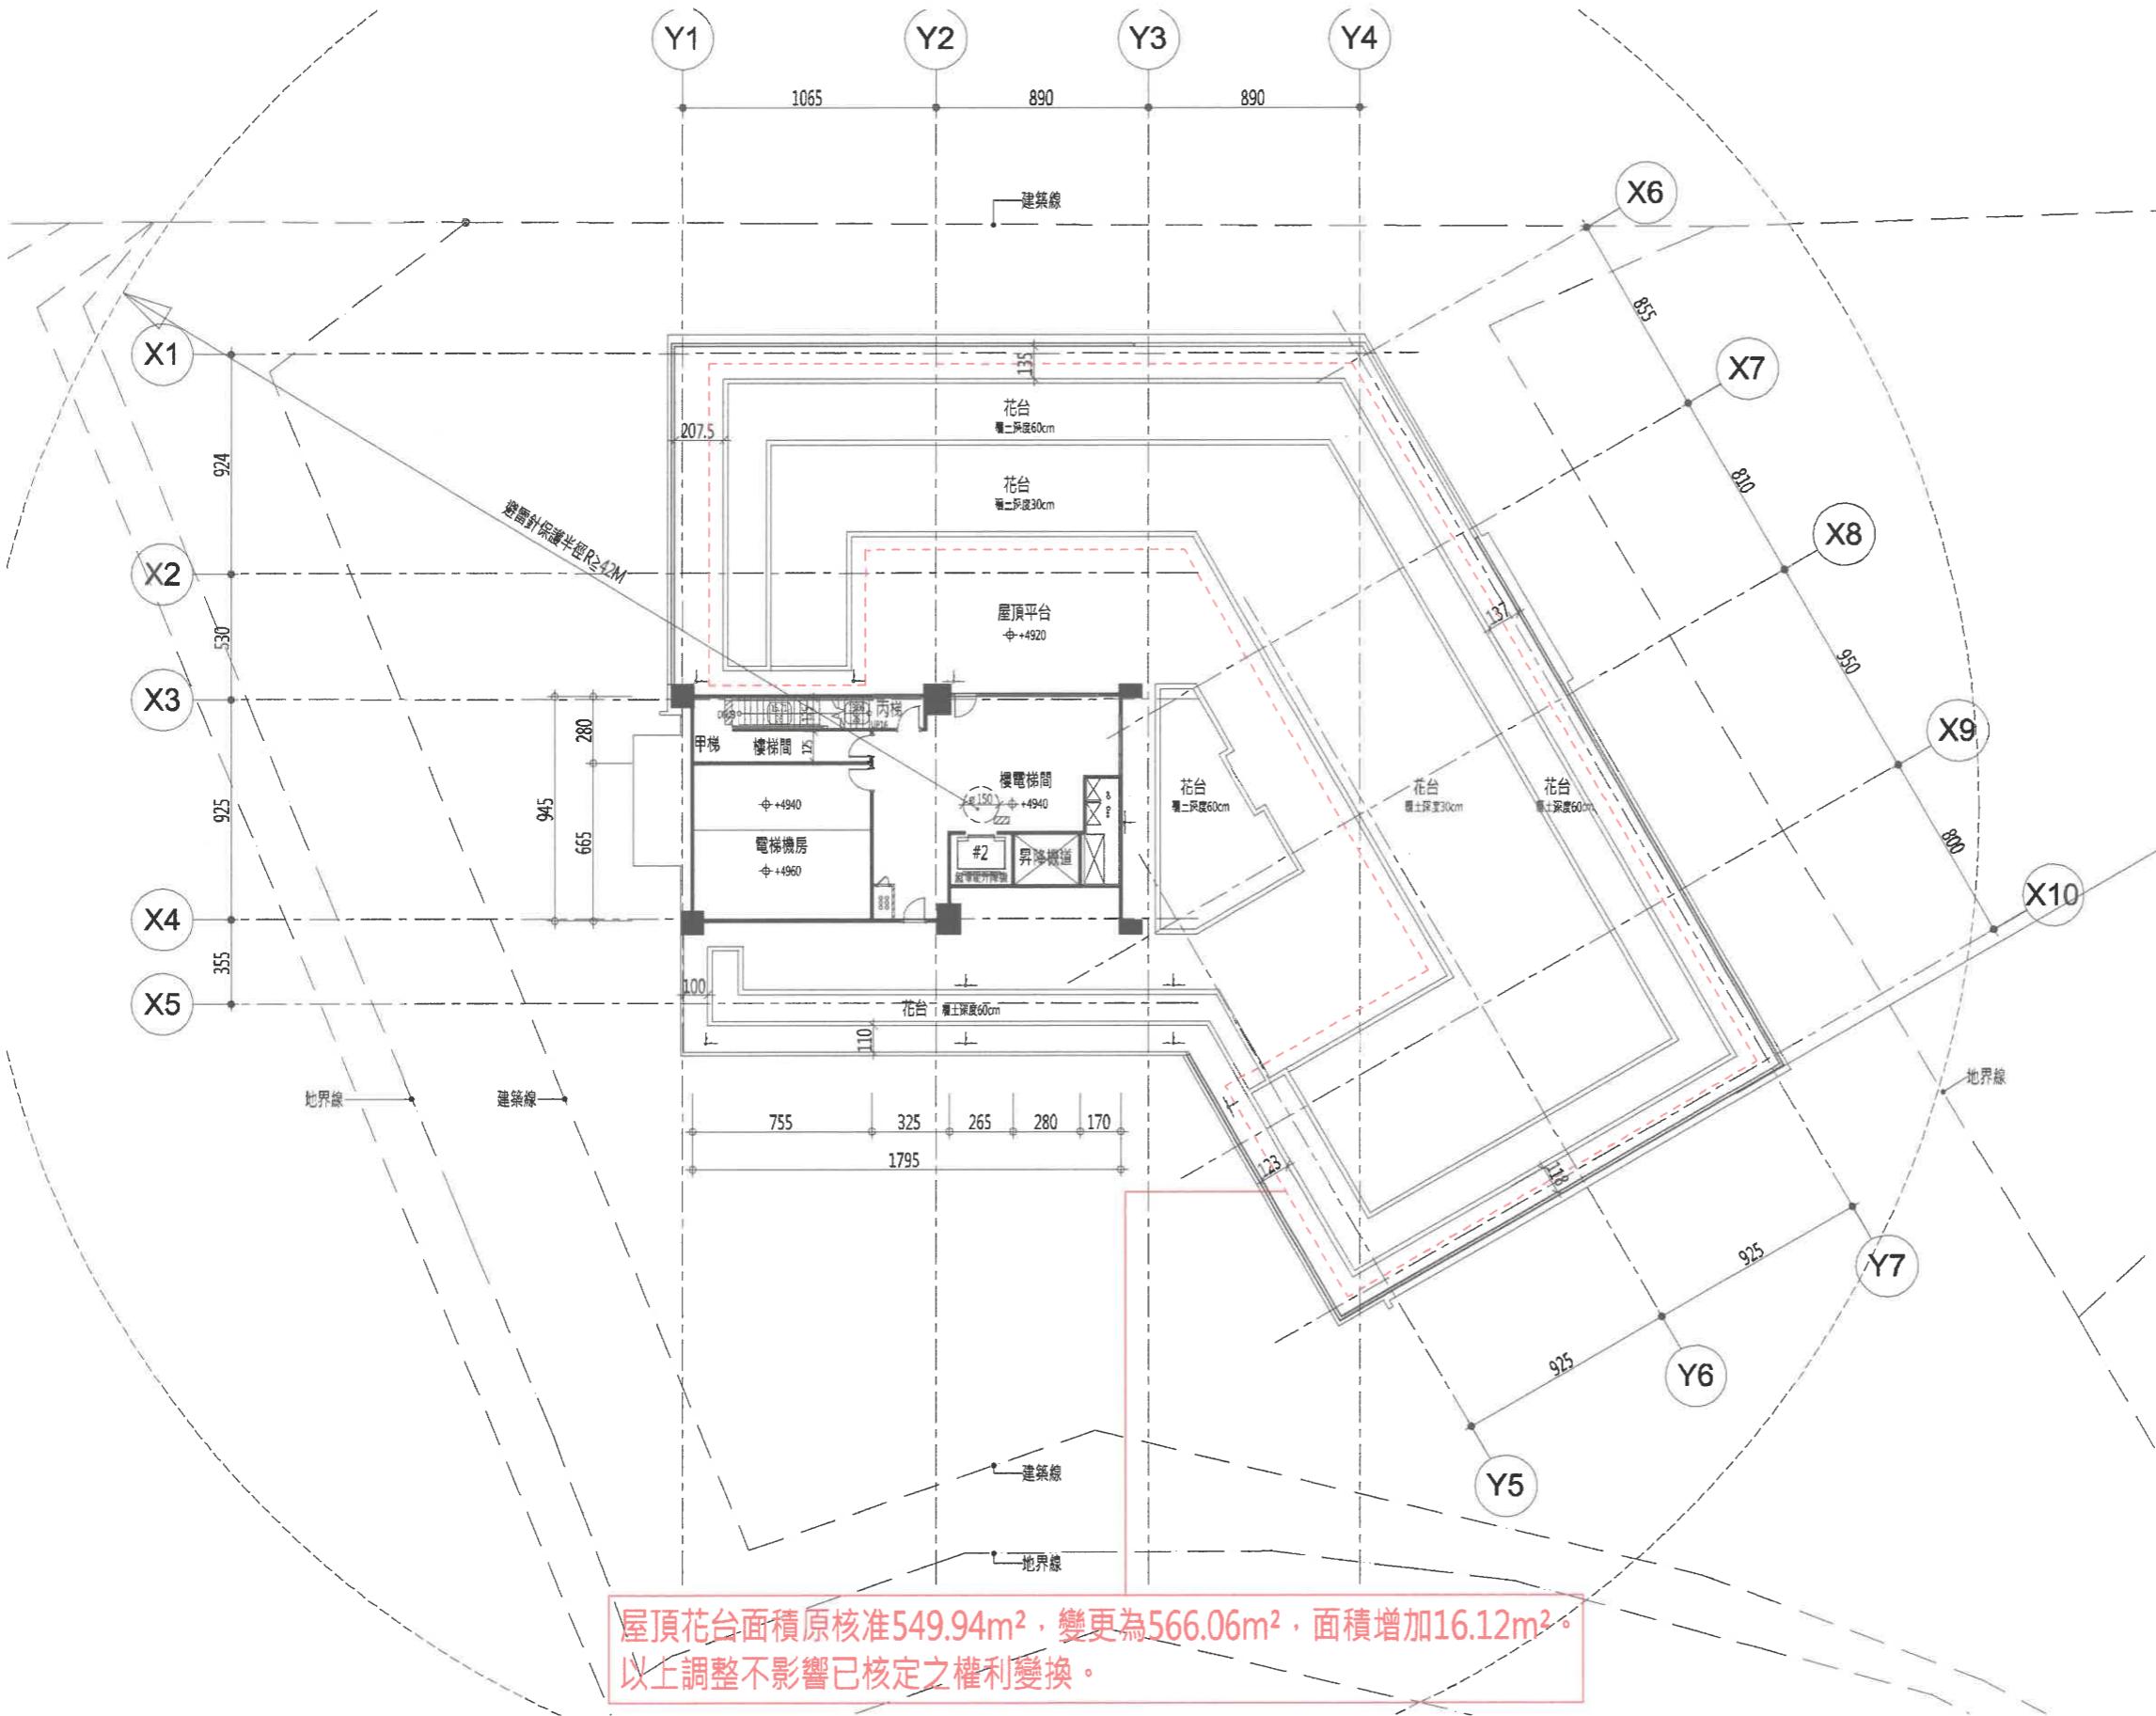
屋突層平面圖(變更後)(S : 1/300)
